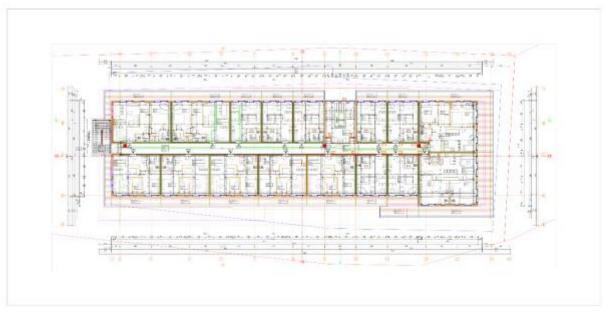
Grundriss 3. Obergeschoss (nicht maßstäblich)
